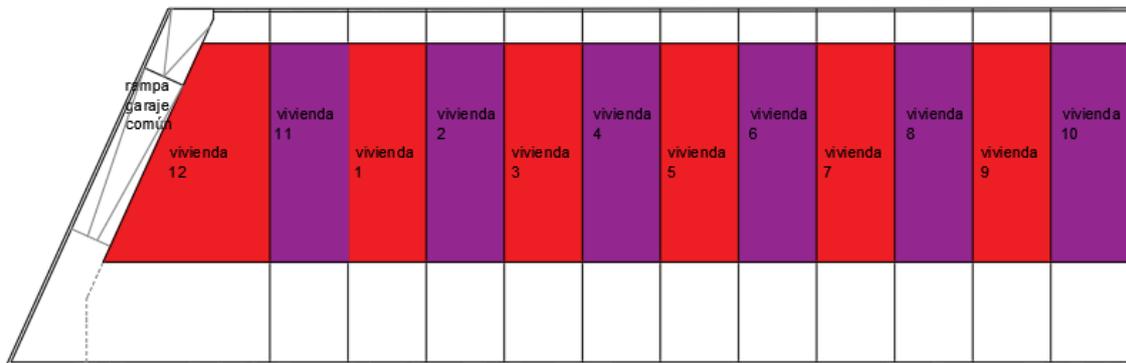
Planta baja promoción de 12 adosados con garaje. Fuente: elaboración propia
